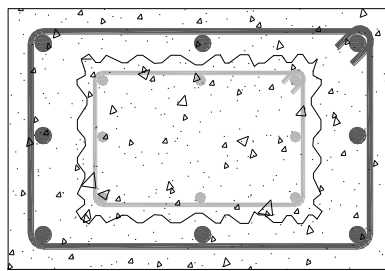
Reforço do Pilar por armadura de flexão-tracção [40]
